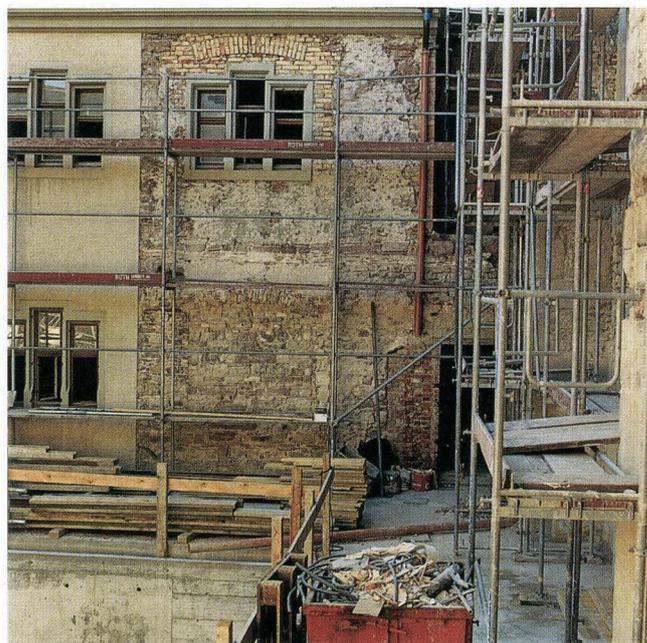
Lohnhof. Ostfassade des Armariums. Der freigelegte Fassadenabschnitt im nördlichen Teil beim Anschluss an die Leonhardskirche zeigt die Bauphase des Bibliotheksbaus von 1440 (unterer Teil = 1. OG) und das 1853 aufgestockte Geschoss mit dem nachträglich eingebauten Stufenfenster, das die «echten» spätgotischen Fenster des unteren Geschosses imitiert. – *Foto: Basler Denkmalpflege.
